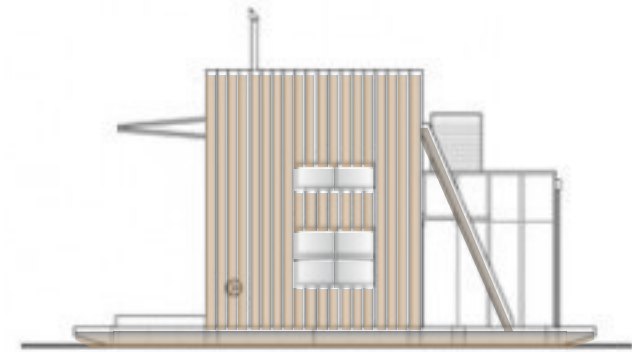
Alzado Este. Fuente: Elaboración propia apartir de información de Crosson Architects
